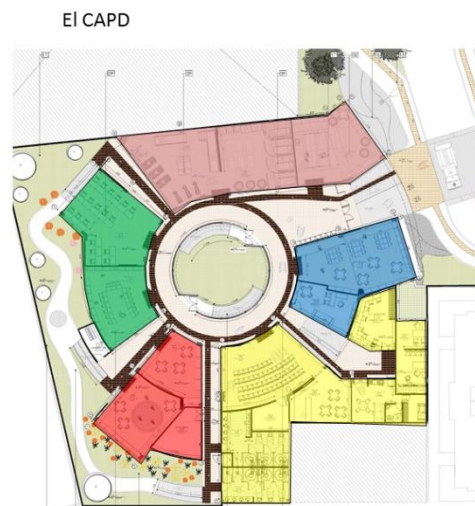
Planta arquitectónica del CAPD (Fuente: Arq. Javier Barrera, 2017)
